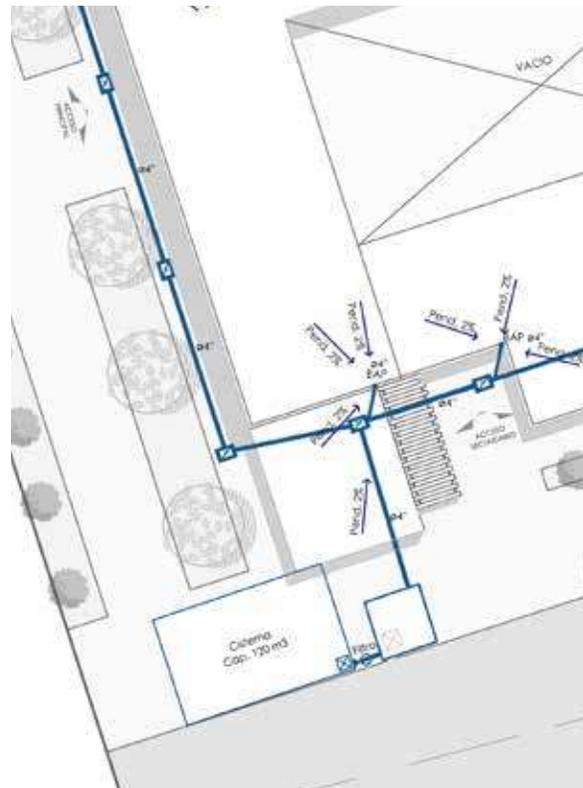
Planta de Instalación Pluvial/Elaborado por LAS
